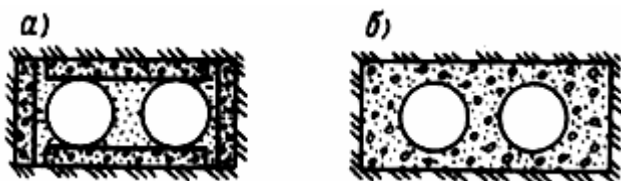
Бесканальная прокладка теплопровода в литом пенобетонном массиве
